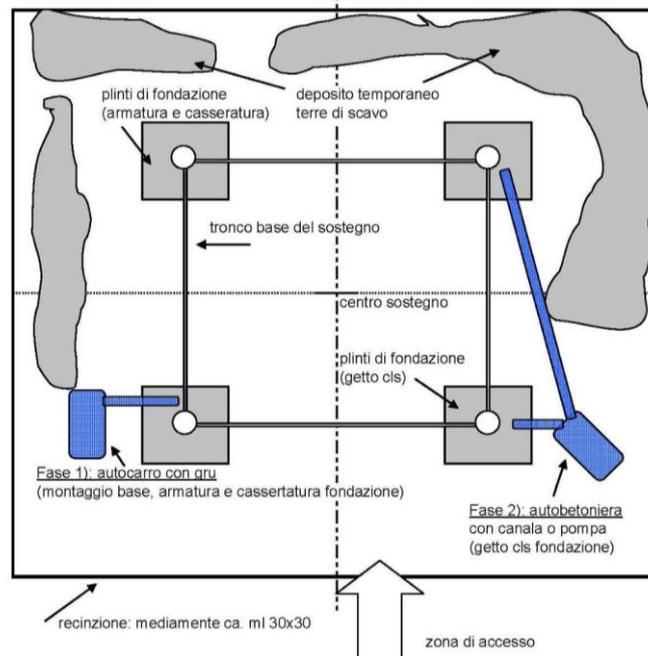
Planimetria dell'area di microcantiere (linea 380 kV) - fase di lavoro: getto e basi
